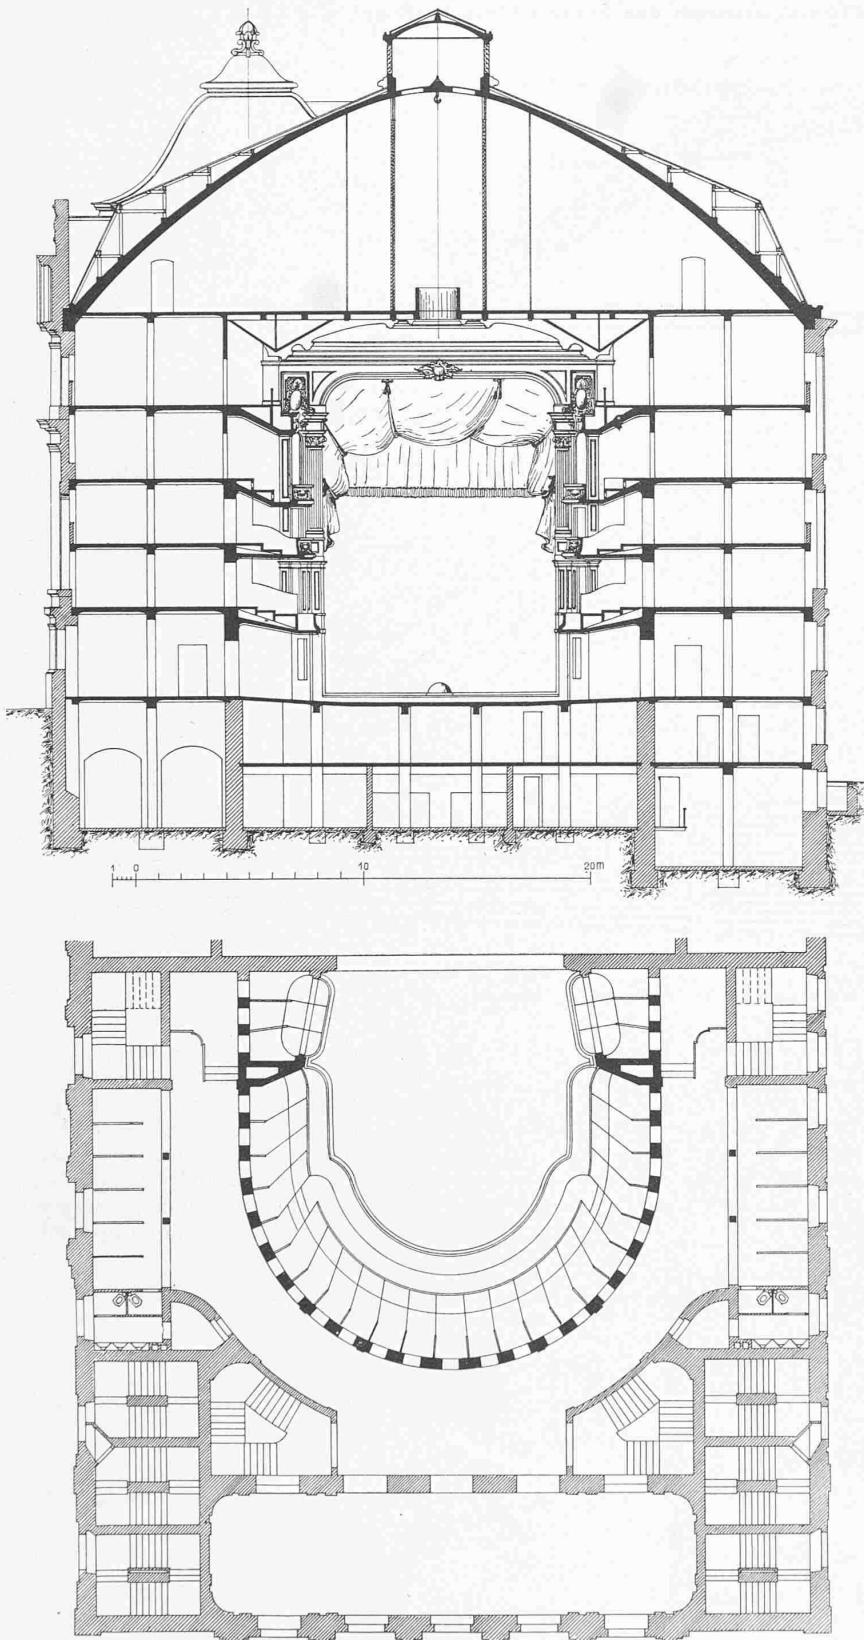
und 2. Querschnitt und Grundriss des Zuschauergebäudes. — 1:300.
